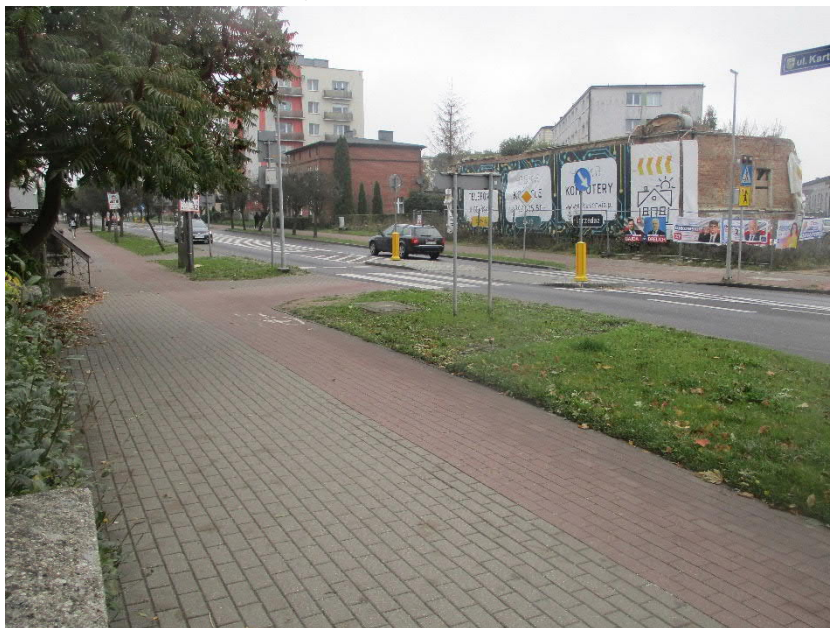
Wlot drogi wojewódzkiej nr 214 (północny) – widok w kierunku północnym – ścieżka pieszo-rowerowa wyznaczona kolorystycznie – brak oznakowania pionowego i przejazdu rowerowego w poprzek drogi wojewódzkiej
